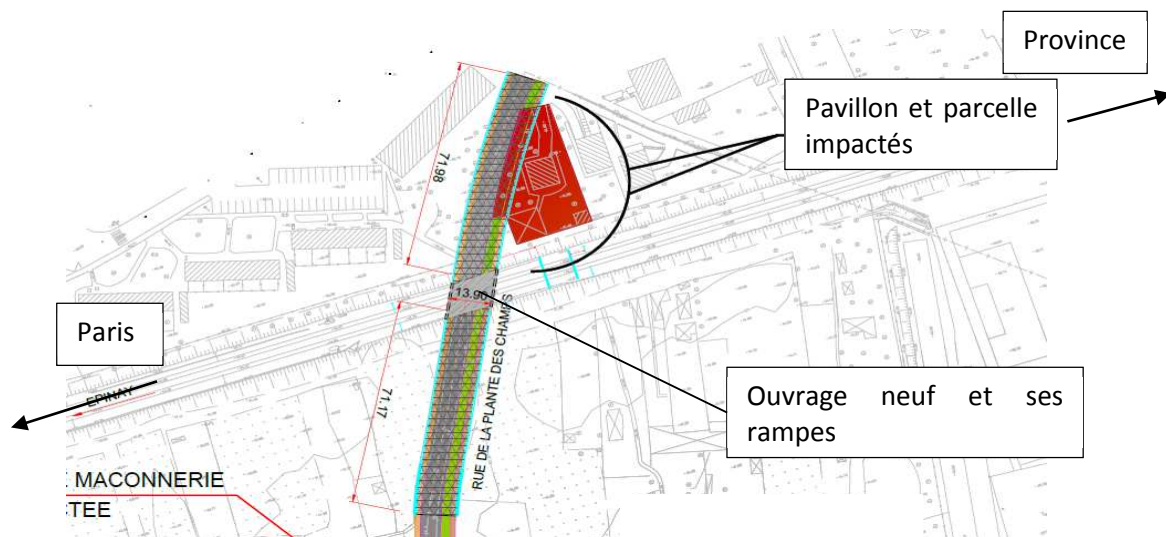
Extrait de plan ouvrage rue de la plante des champs
